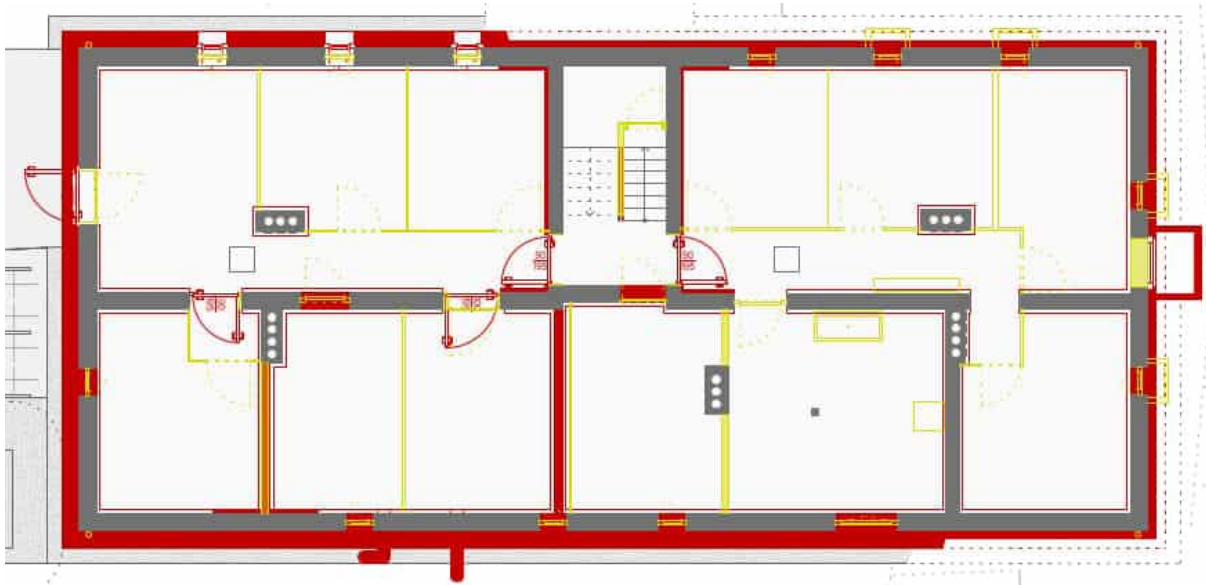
großes Gebäude, Grundriss KG, Änderungen gegen Bestand, ohne Maßstab; Johannes Kaufmann und Partner GmbH; gelb: Abriss, rot: neues Bauteil, neue Bauteilschicht/Komponente, grau: Bestand
